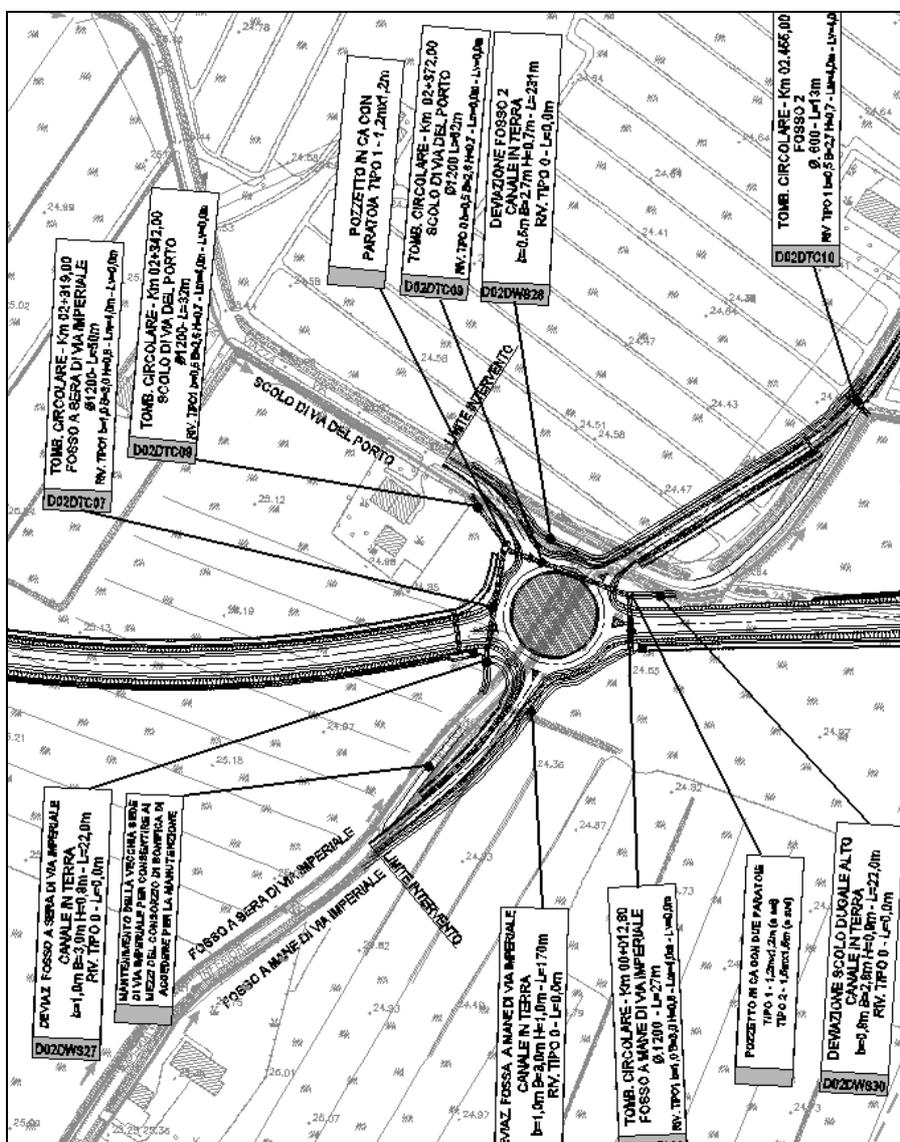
STRALCIO PLANIMETRICO DELLA RISOLUZIONE IDRAULICA DEL NODO DI VIA IMPERIALE
